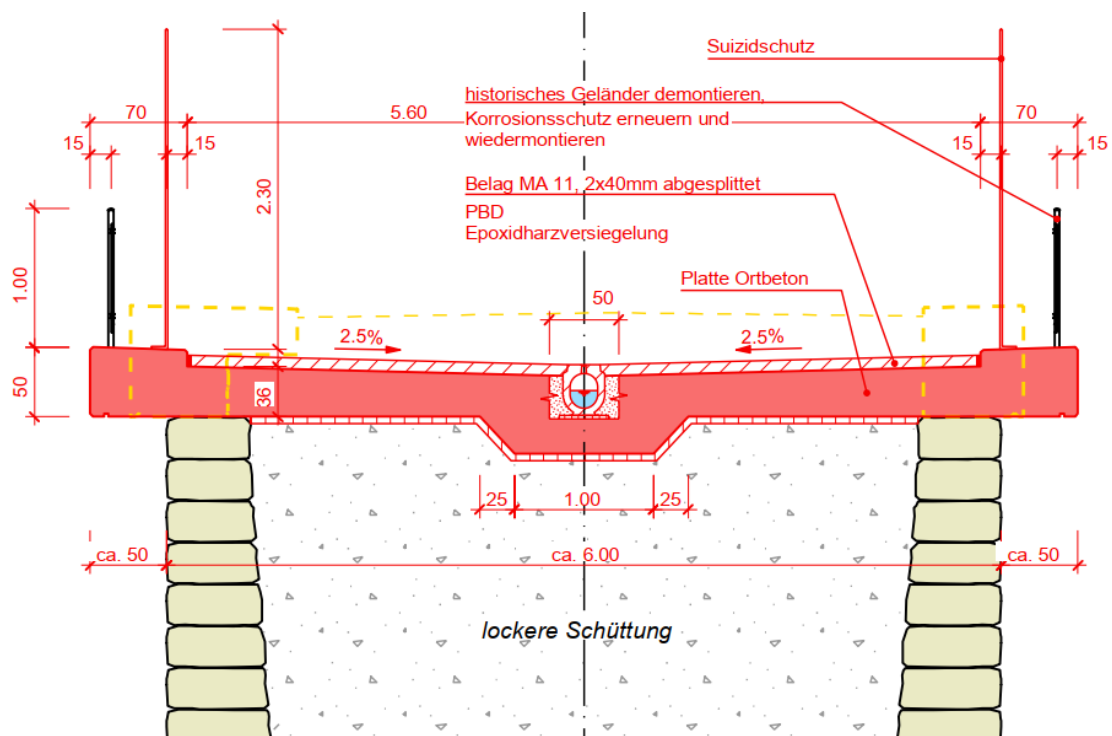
Brückenquerschnitt mit geplanter Betonfahrbahnplatte
